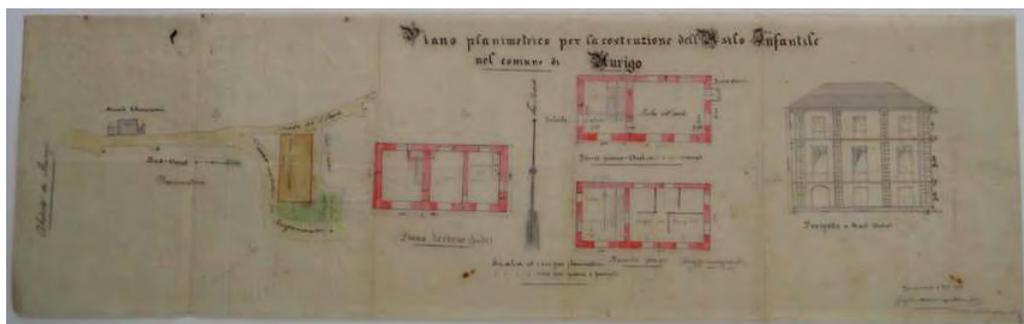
Progetto dell'Asilo con la Planimetria generale (Progettista Massimo Guglieri di Borgomaro, 1 Settembre 1923).
